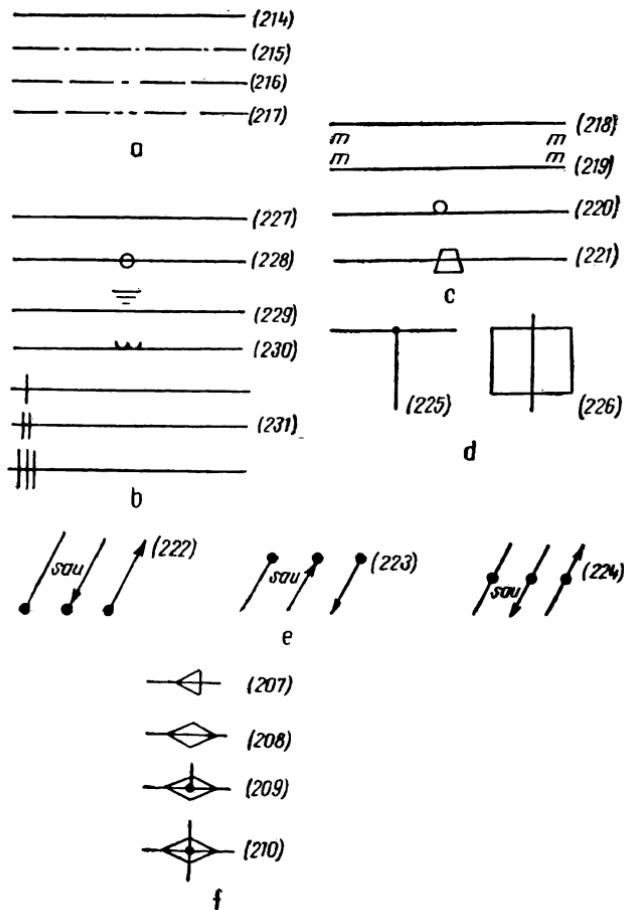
Semne convenționale folosite în planurile rețelelor electrice și ale elementelor constructive ale instalațiilor electrice interioare.
